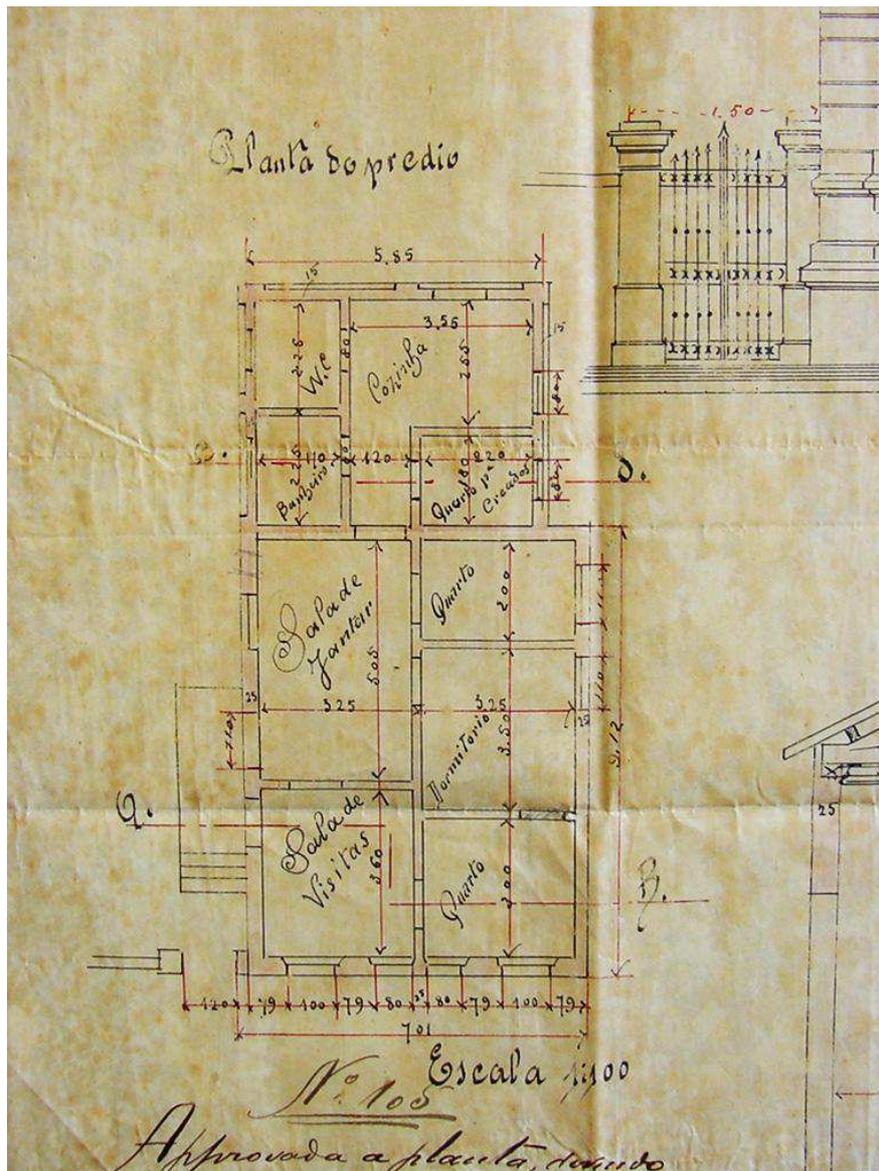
Planta do projeto de Luiz Olivieri referente à construção erigida na Rua Tupis no ano de 1897. Lote 21, Quadra 26.
